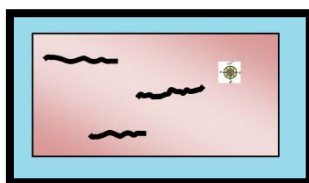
Planta de los parapetos. Sin escala. Fuente: Elaboración propia.
